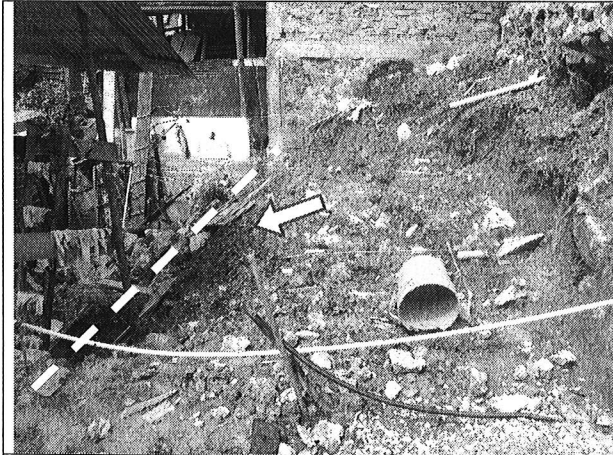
Vista del relleno que se encontraba confinado por el muro en bloques de concreto. La línea punteada señala el paramento del muro previo al colapso.
